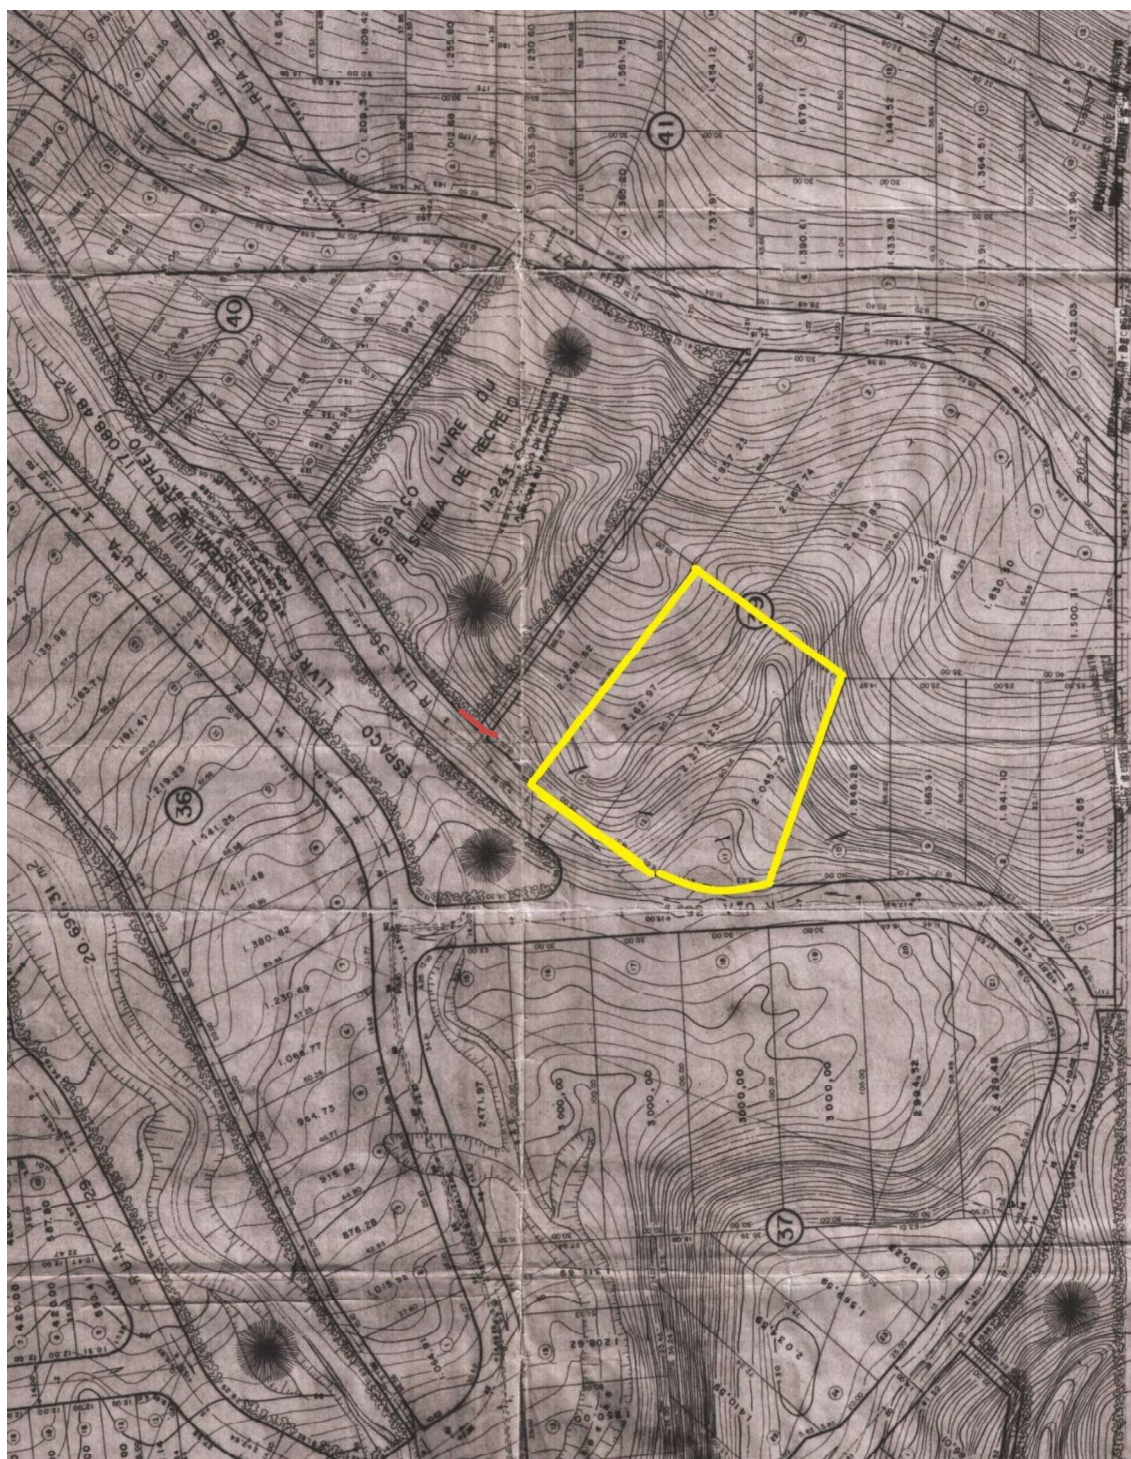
Imagem da planta de loteamento em amarelo os lotes.
